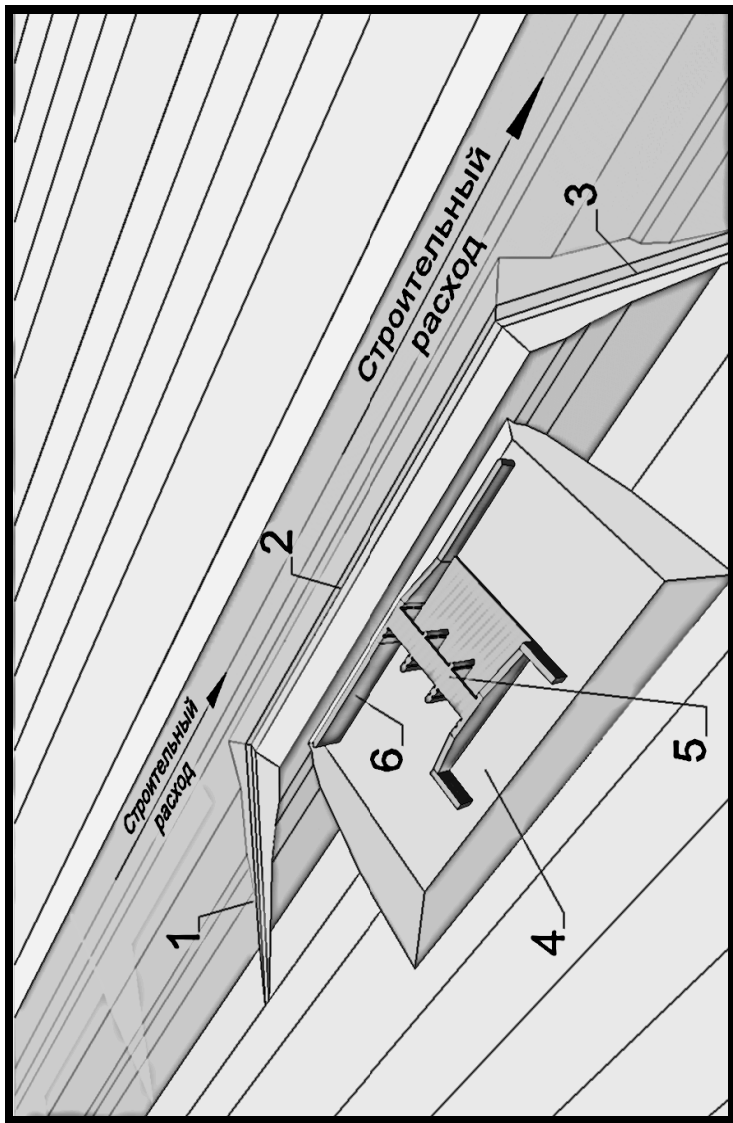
Схема пропуска строительных расходов первой очереди строительства «Русловая компоновка»: 1, 2, 3 – верхняя, продольная и низовая перемычки соответственно первой очереди строительства; 4 – котлован под бетонное сооружение; 5 – строящееся бетонное сооружение первой очереди строительства (водобросная плотина); 6 – разделительная стенка
